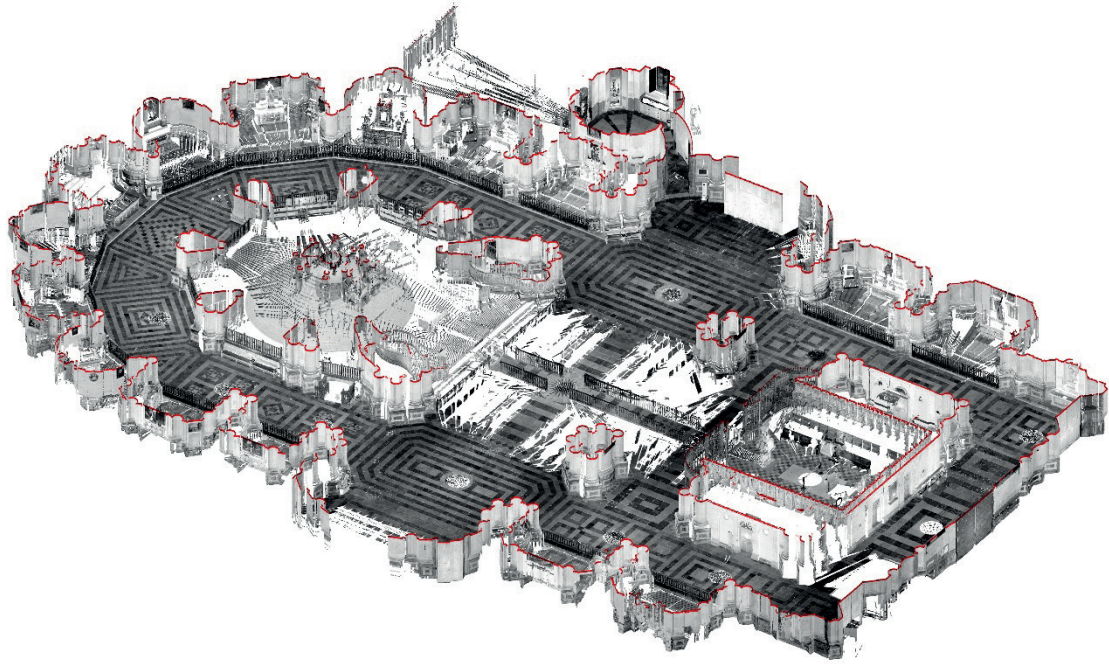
Vista en perspectiva de la distribución en planta de la catedral. Fuente: elaboración propia
